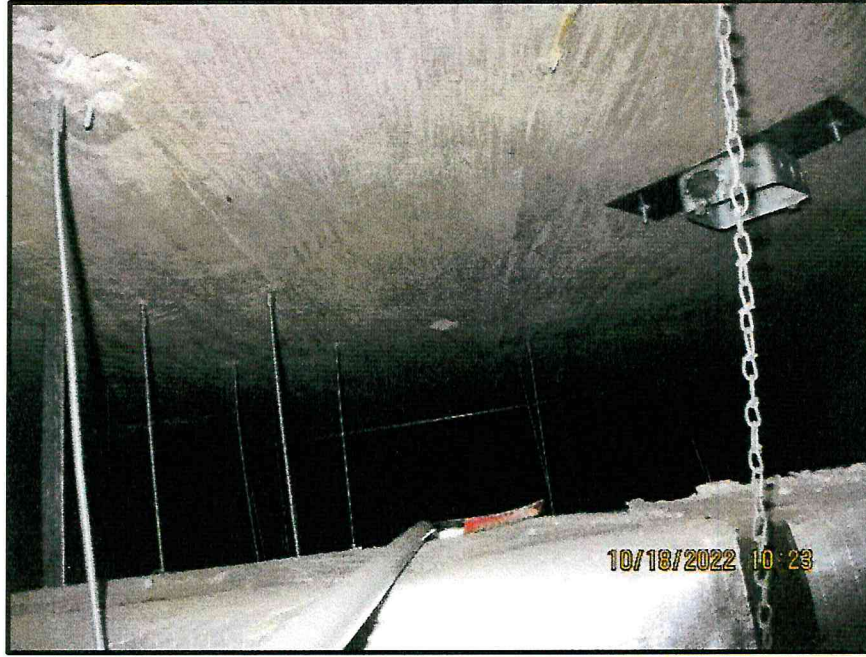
Vista en interior de Plafond colganteado, donde se aprecia la losa maciza
